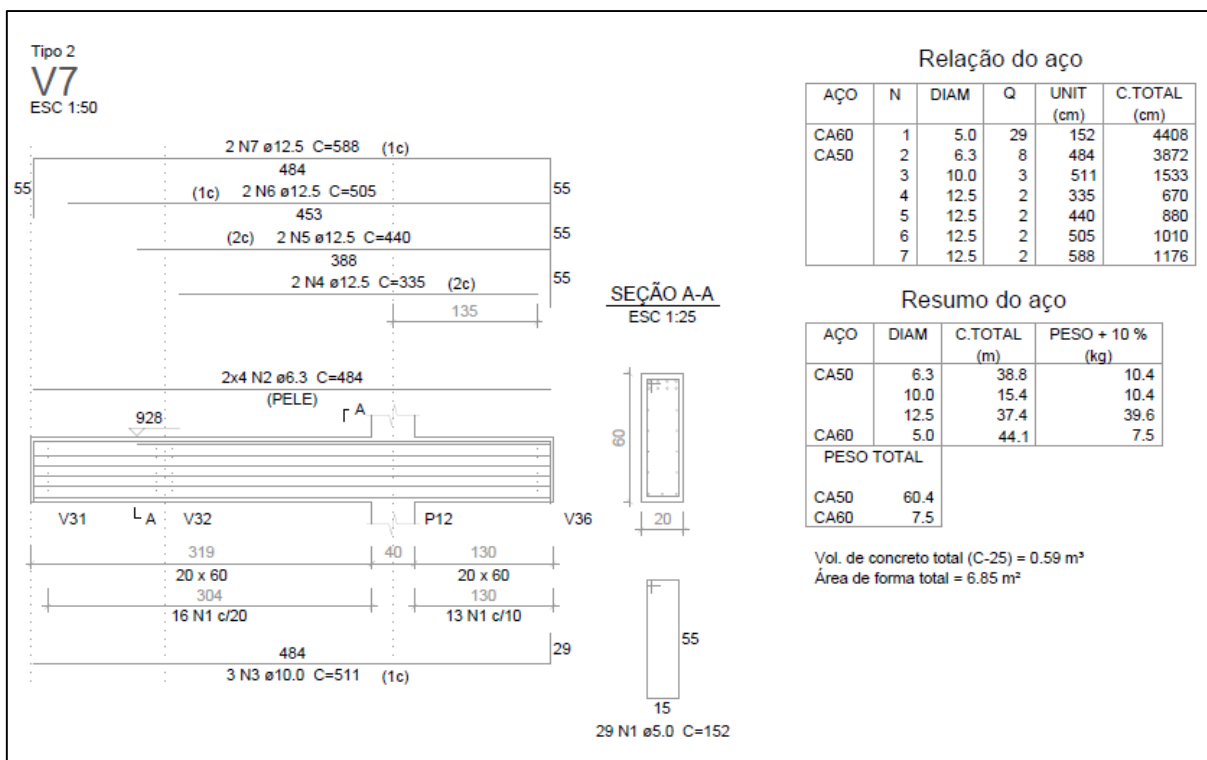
Detalhamento da Viga V07 no projeto com *drywall
